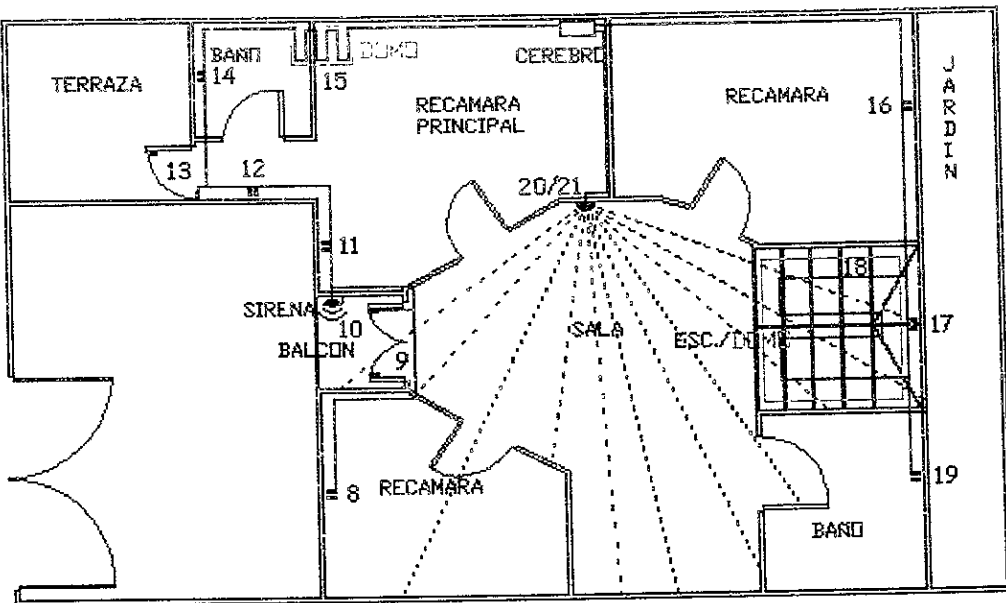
Croquis de la planta alta de la casa habitación.
